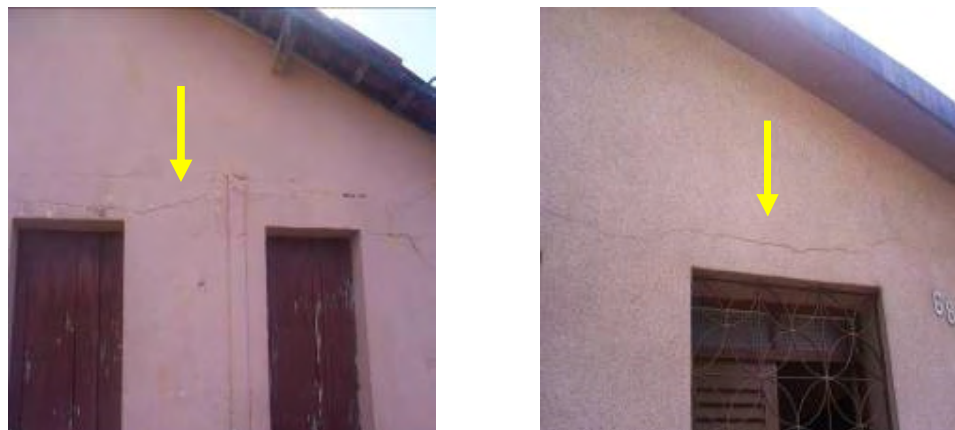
Fissuras horizontais, em alvenarias.
